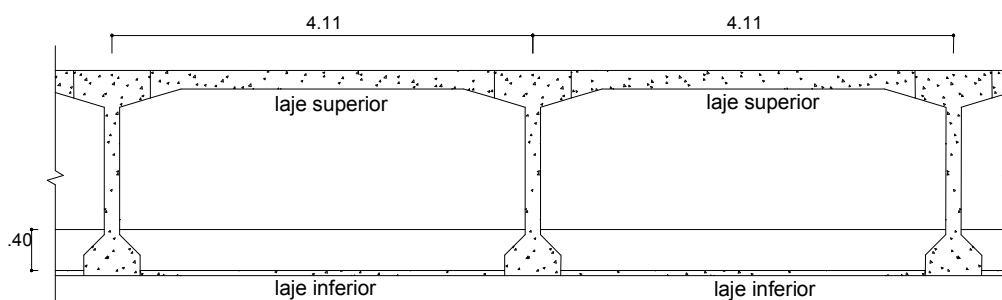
Disposição das lajes superiores e inferiores em relação às longarinas
